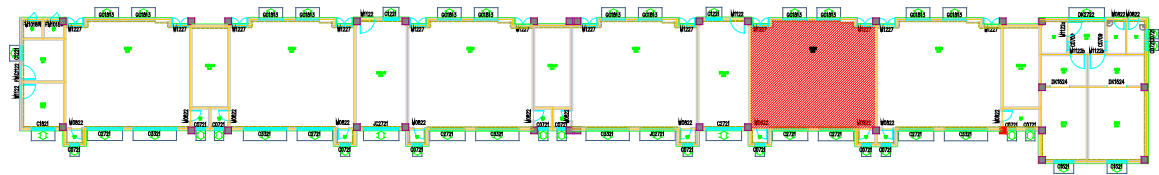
受建筑外部噪声影响的典型房间楼层平面图
